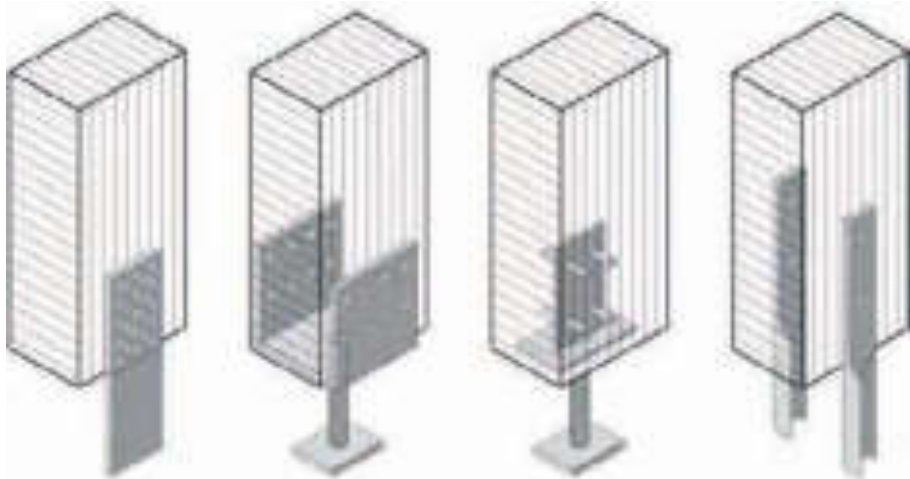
Esempi di collegamento pilastro-fondazione realizzato con piastre metalliche e travi radice.
